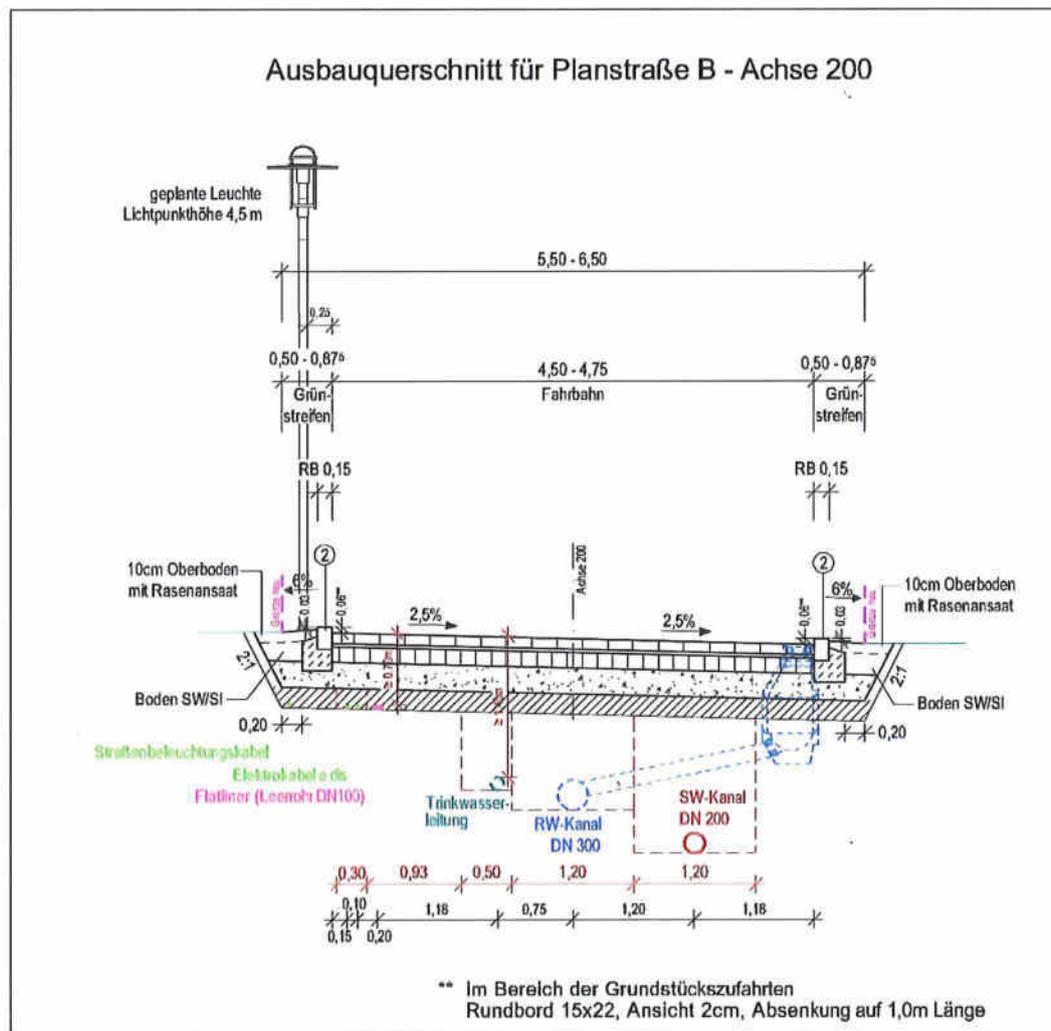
Empfehlung für den Straßenquerschnitt – Regelquerschnitt – Planstraße B (Quelle: Ausführungsplanung, IBL Schwerin – Ingenieurbüro Leirich, Stand: 11/2022)
